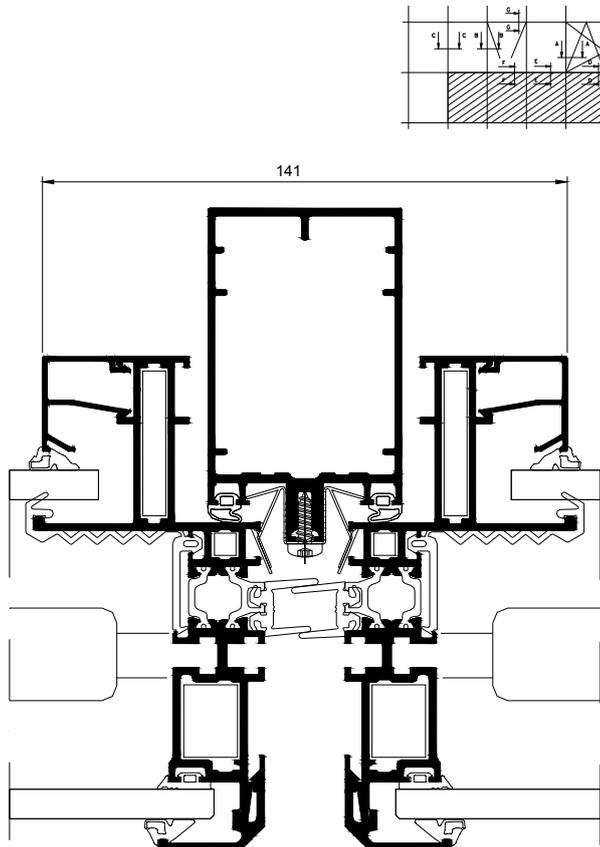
VEP Fixe – Coupe horizontale C.C – Variante lame d'air de 78 mm
